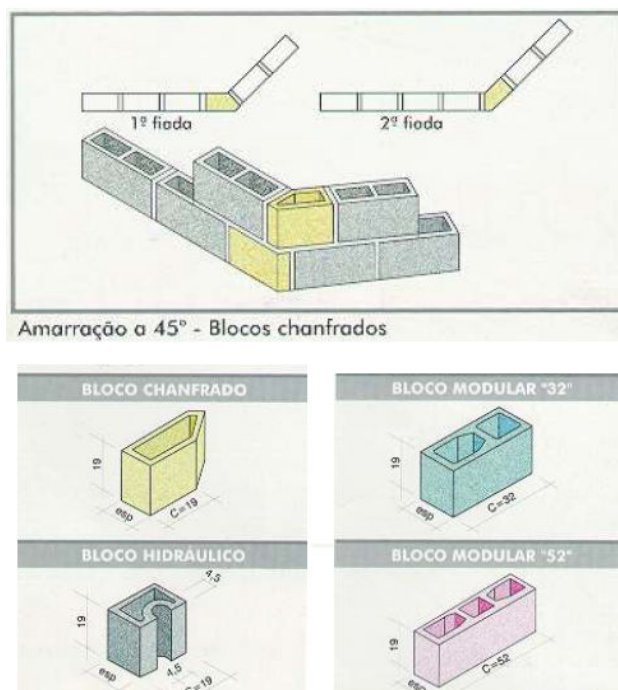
Elementos especiais da alvenaria de bloco de concreto.
